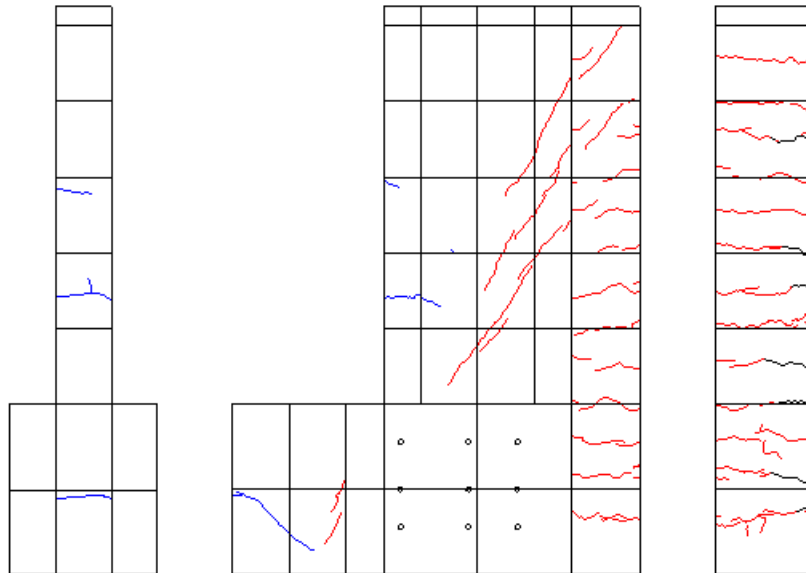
R=-1/200 ひび割れ図
